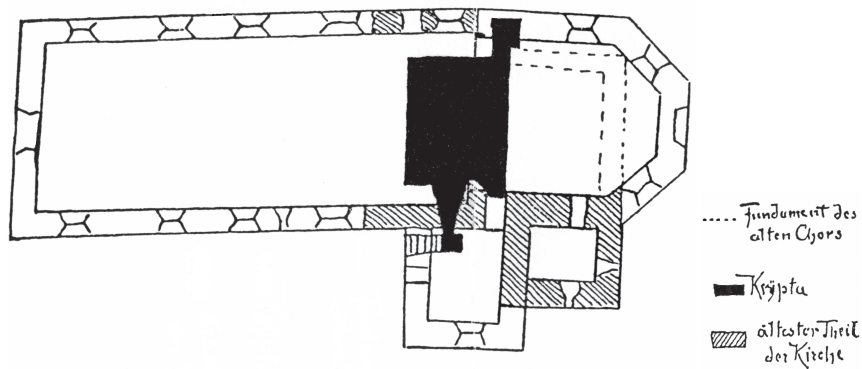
Grundrißzeichnung von 1890 mit Lage der Krypta (dunkel) quer zum Gebäude, deren Ausgang nach Süden und der erfaßten Mauerreste eines Vorgänger(rechteck)chors (gestrichelt) sowie den damals angenommenen Bauabfolgen
